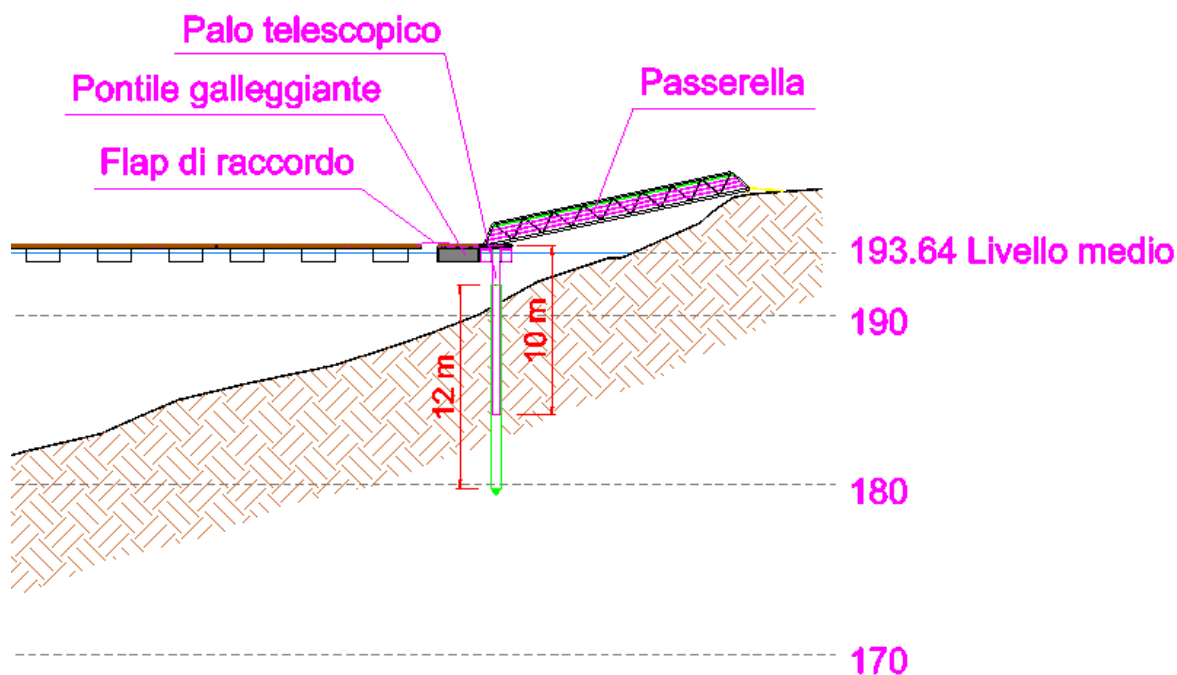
Sezione del pontile di riva, pali telescopici e passerella
